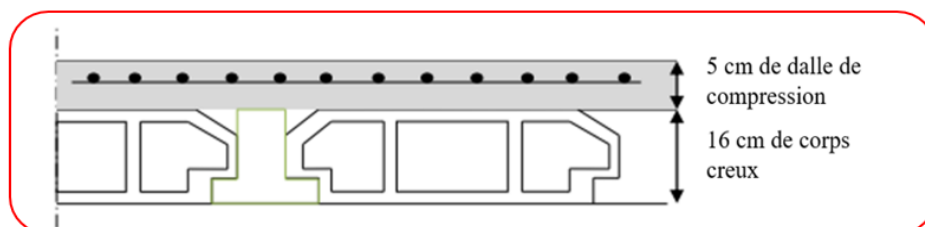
Coupe verticale d'un plancher à corps creux
